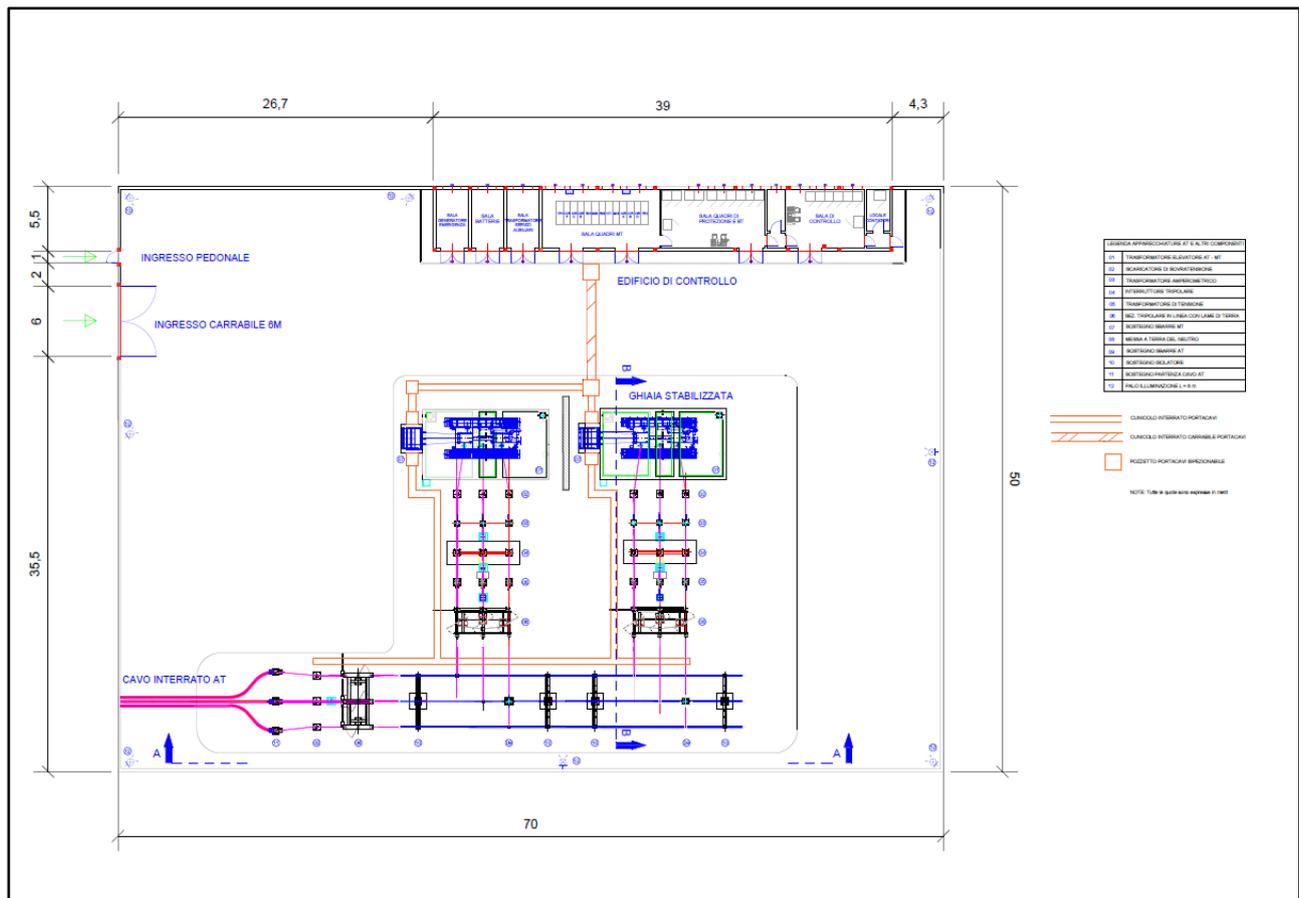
Planimetria elettromeccanica della Stazione Utente
